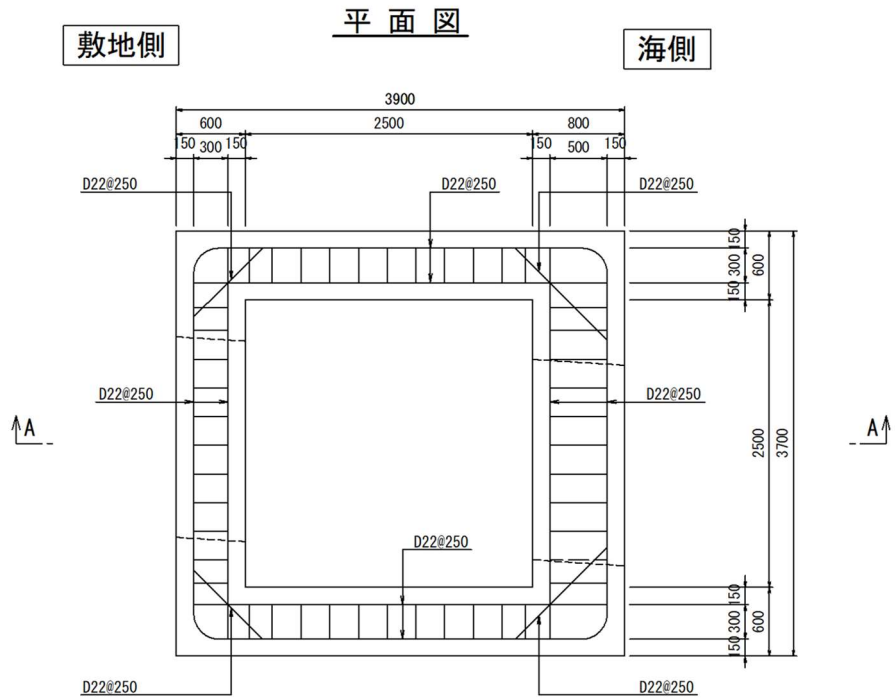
(9) 概略配筋図 (集水柵 (屋外排水路逆止弁⑫))
